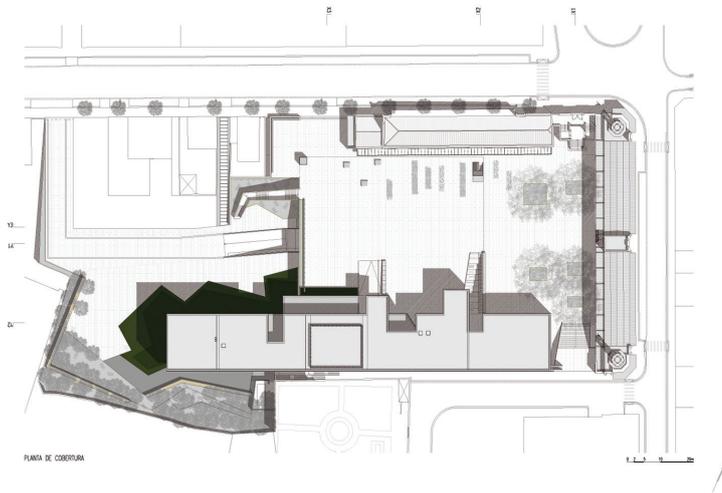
Plataforma das Artes e Criatividade, planta de implantação
